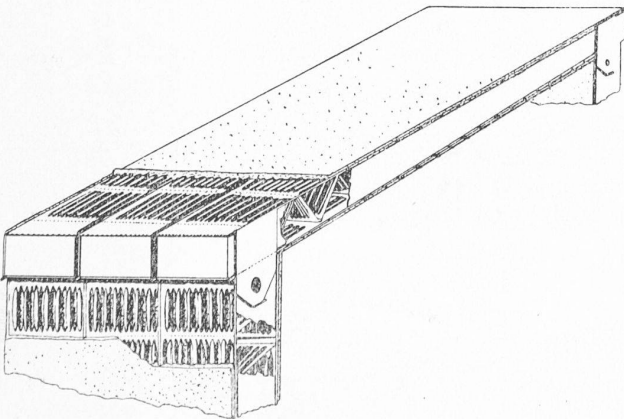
Détail d'assemblage des éléments verticaux et horizontaux.
